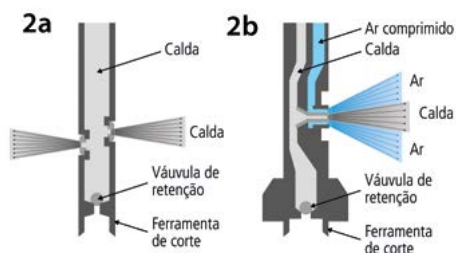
Sistemas de jet-grouting. a) monofluido e b) bifluido (modificado - Croce et al, 2014)
